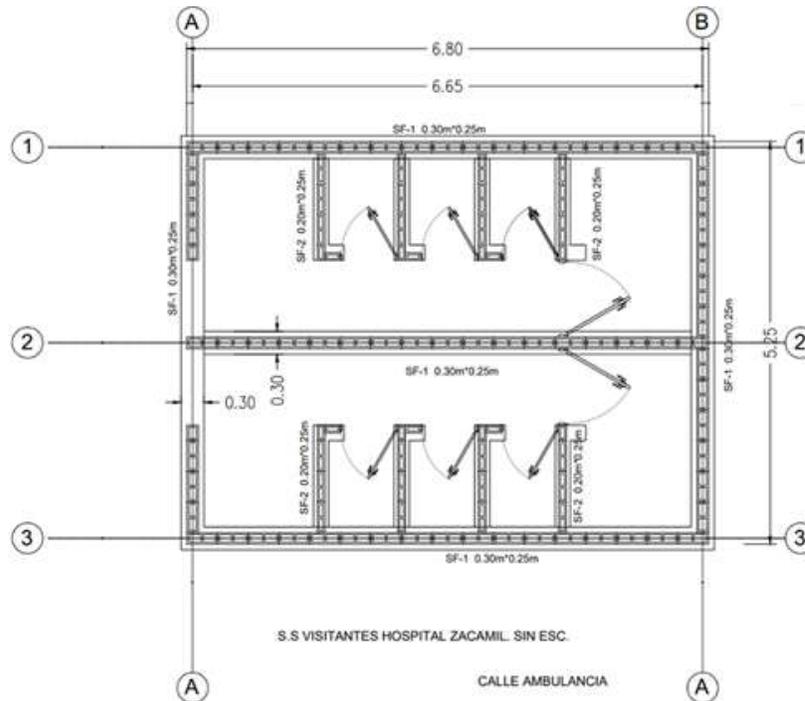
Distribución en planta. Fuente: Elaboración propia
